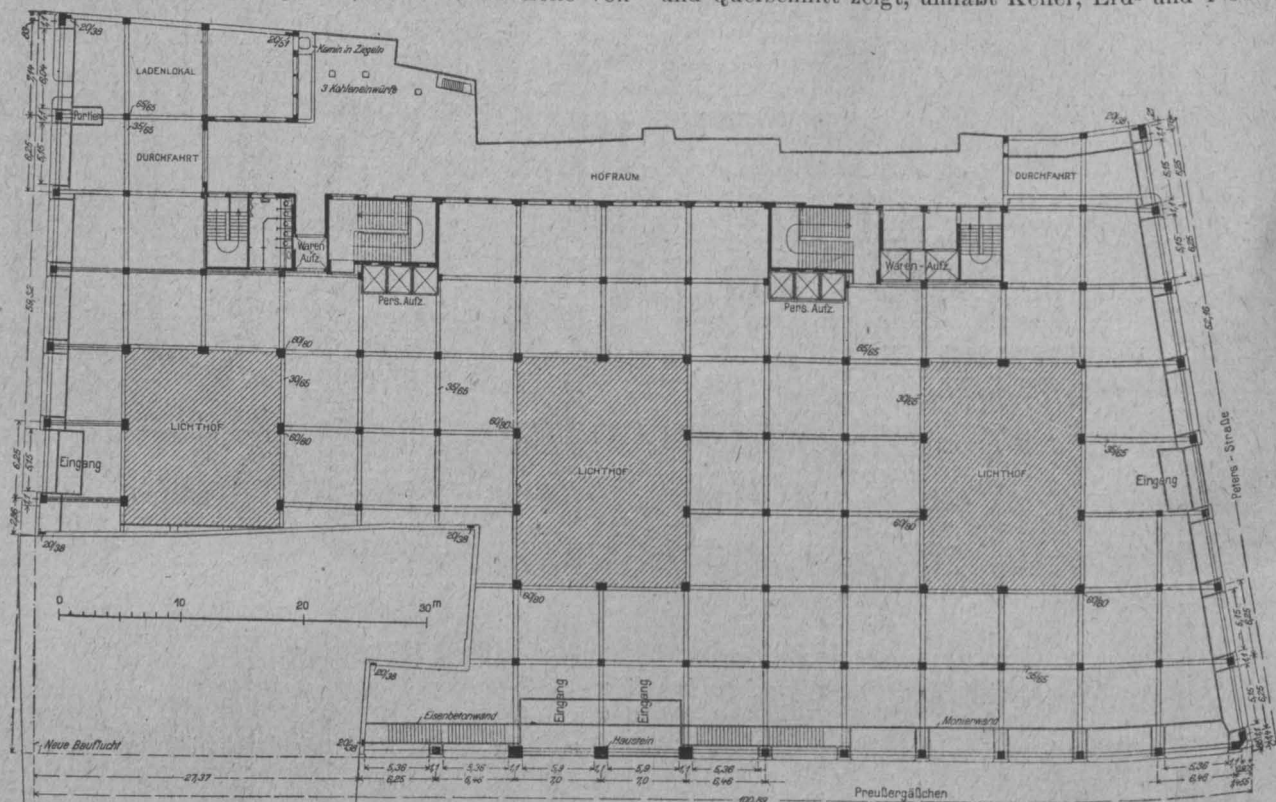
Gesamt-Grundriß des Erdgeschosses mit Angabe der Stützen und Deckenbalken.
